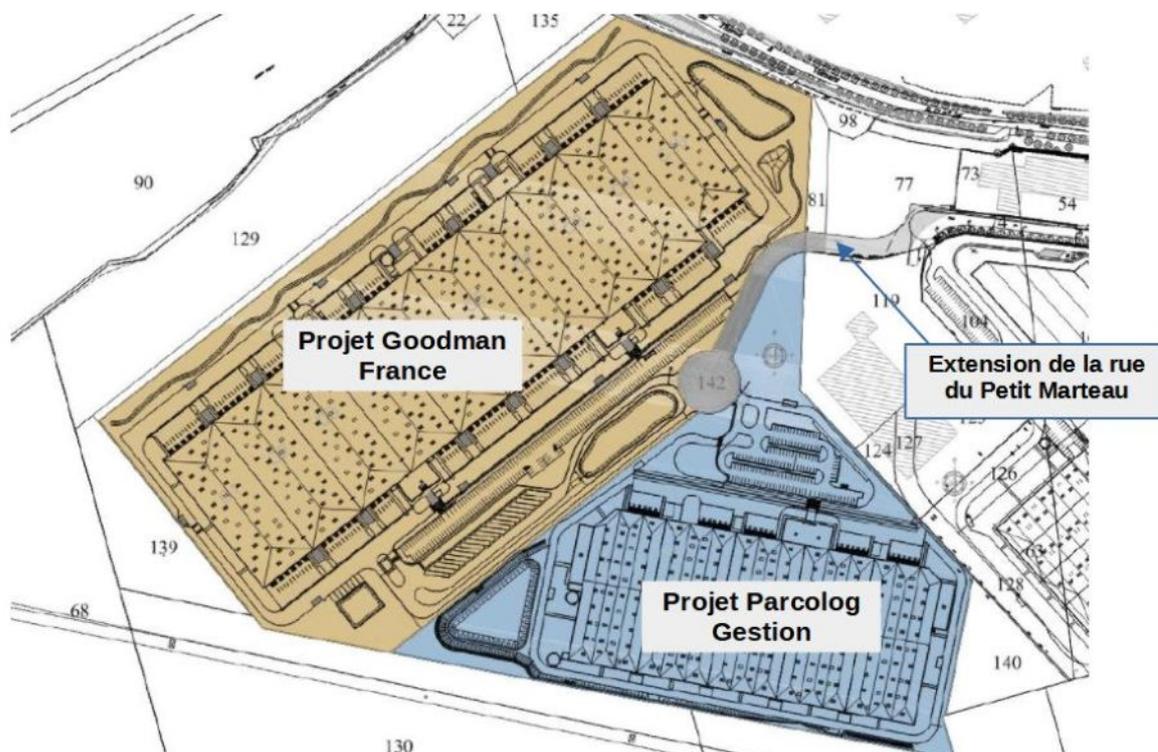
Plan masse du projet d'extension de la ZAE de la Barogne (source : dossier loi sur l'eau, p. 18)
